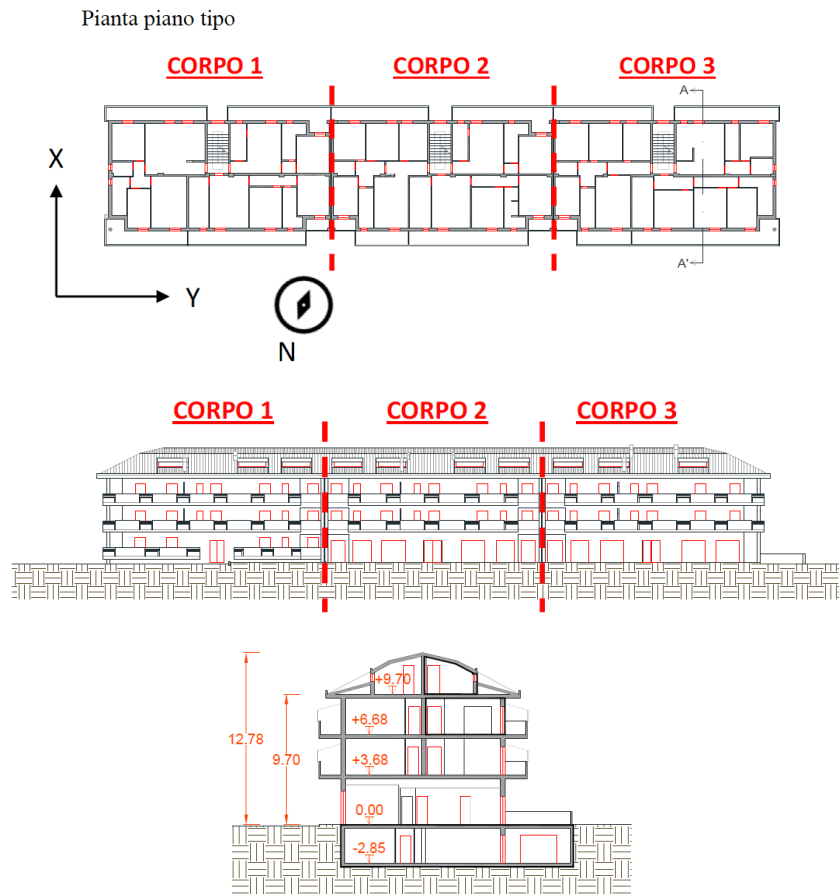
Pianta, prospetto e sezione Condominio Mantova
